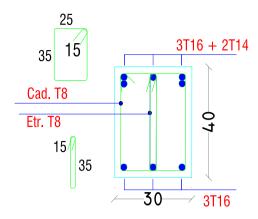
Ferraillage des poutres principales pour Etage 8.
